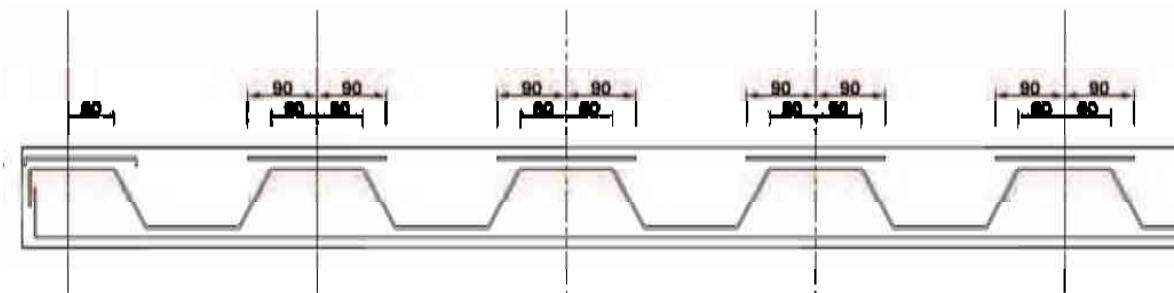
DETALLE DE ARMADO DE LOSA
